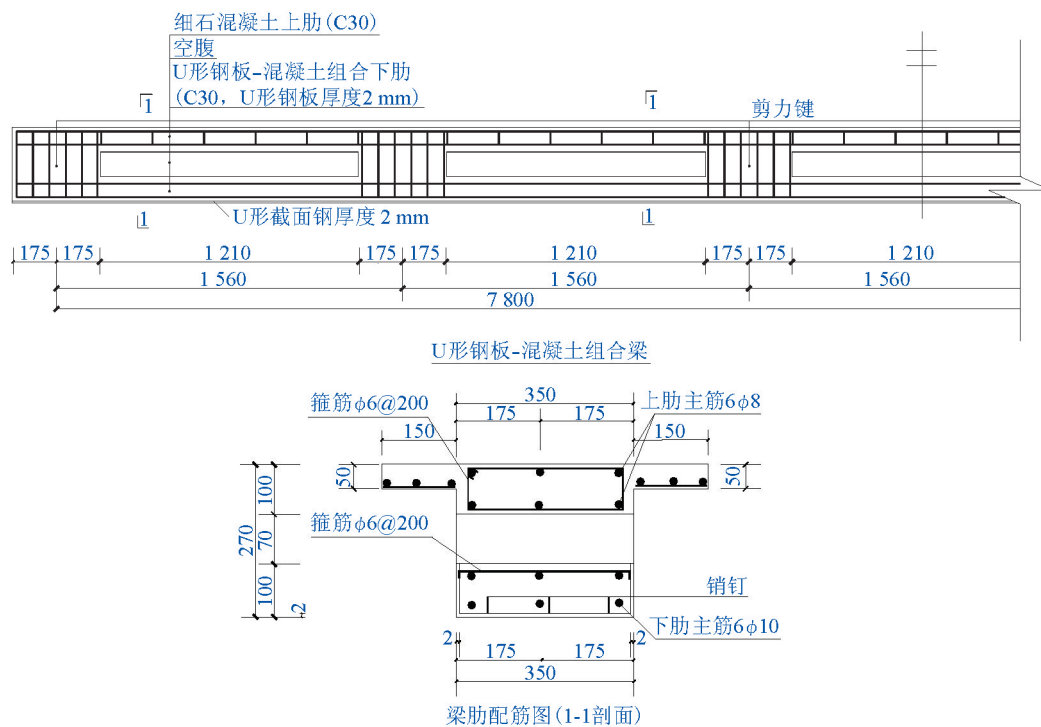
U形钢板-混凝土组合梁施工图(单位:mm)
